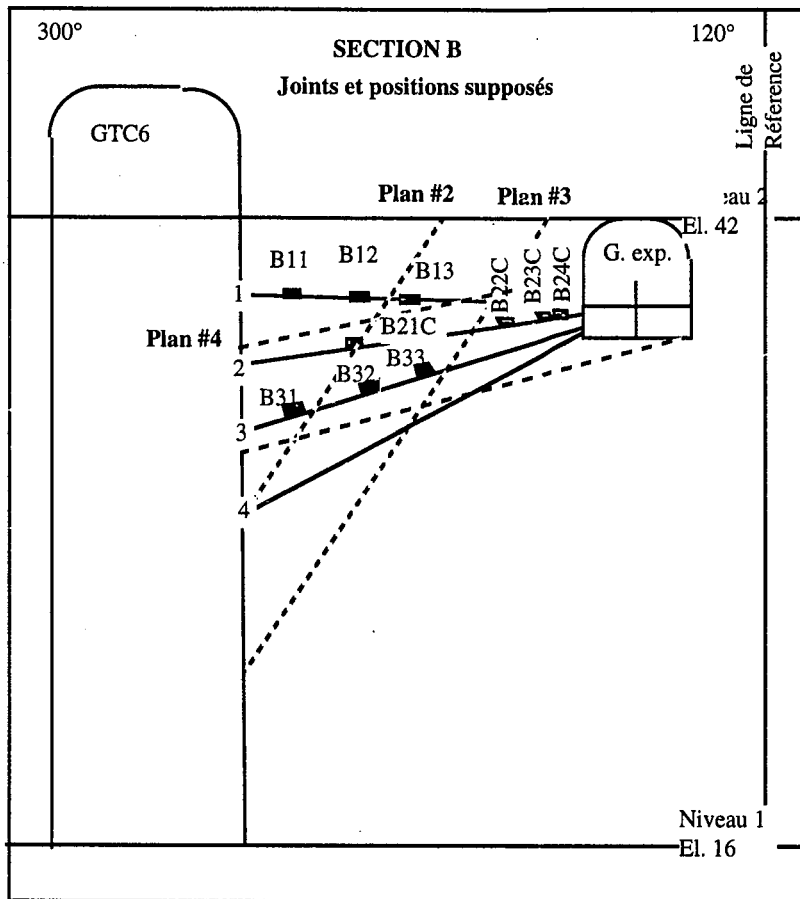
Profil B avec les plans 2, 3 et 4
